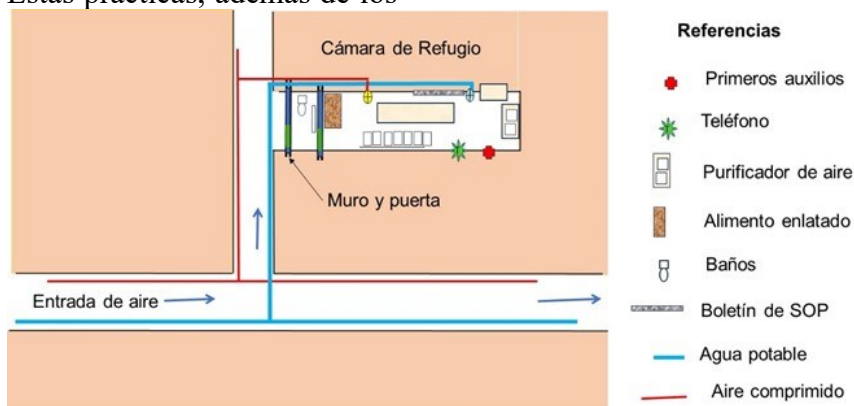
Cámara de refugio equipado para una sección de trabajo (planta).
